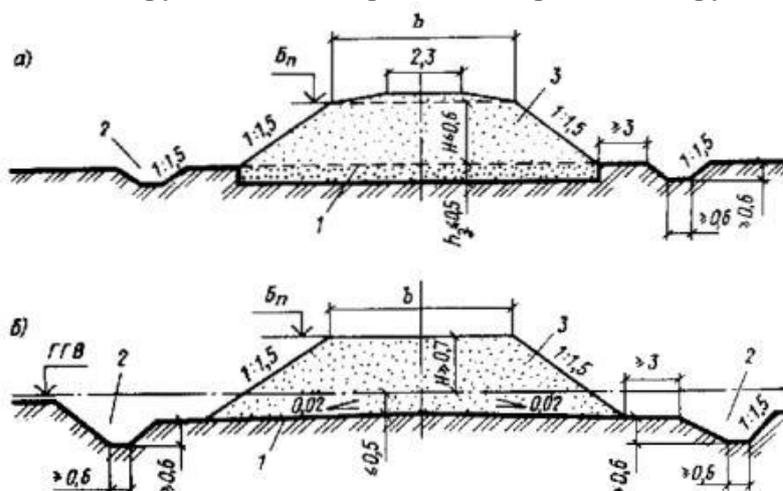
Конструкция насыпи на засоленных грунтах: а - на сухом основании из дренирующих грунтов; б - на участках с неглубоким залеганием уровня грунтовых вод, периодически выходящих на дневную поверхность; 1 - поверхность земли; 2 - канава; 3 - дренирующий грунт; h_3 - глубина замены засоленного грунта на дренирующий грунт; Н - высота насыпи
